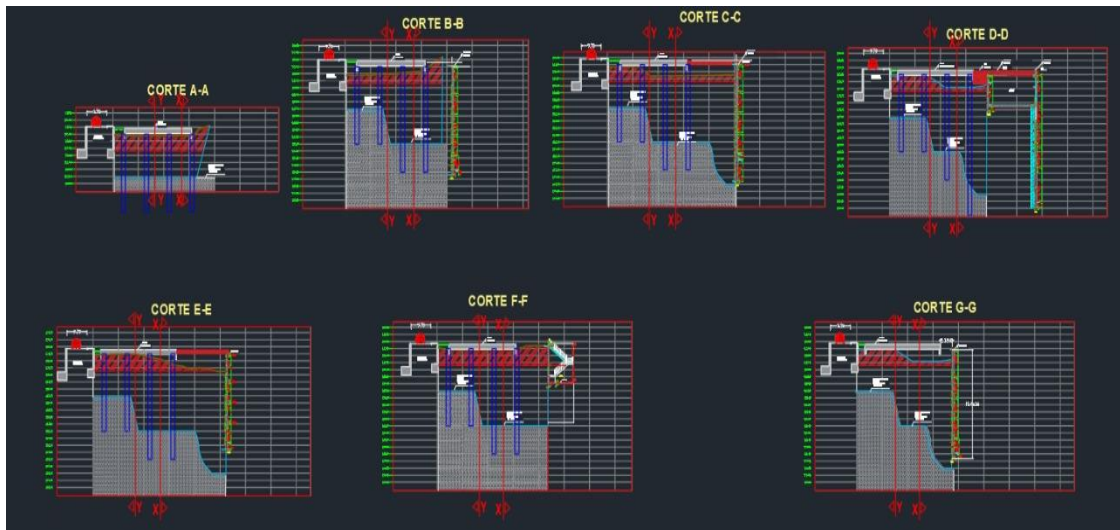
Sección G-C del plano Planta principal suelos 7 y 8 V
